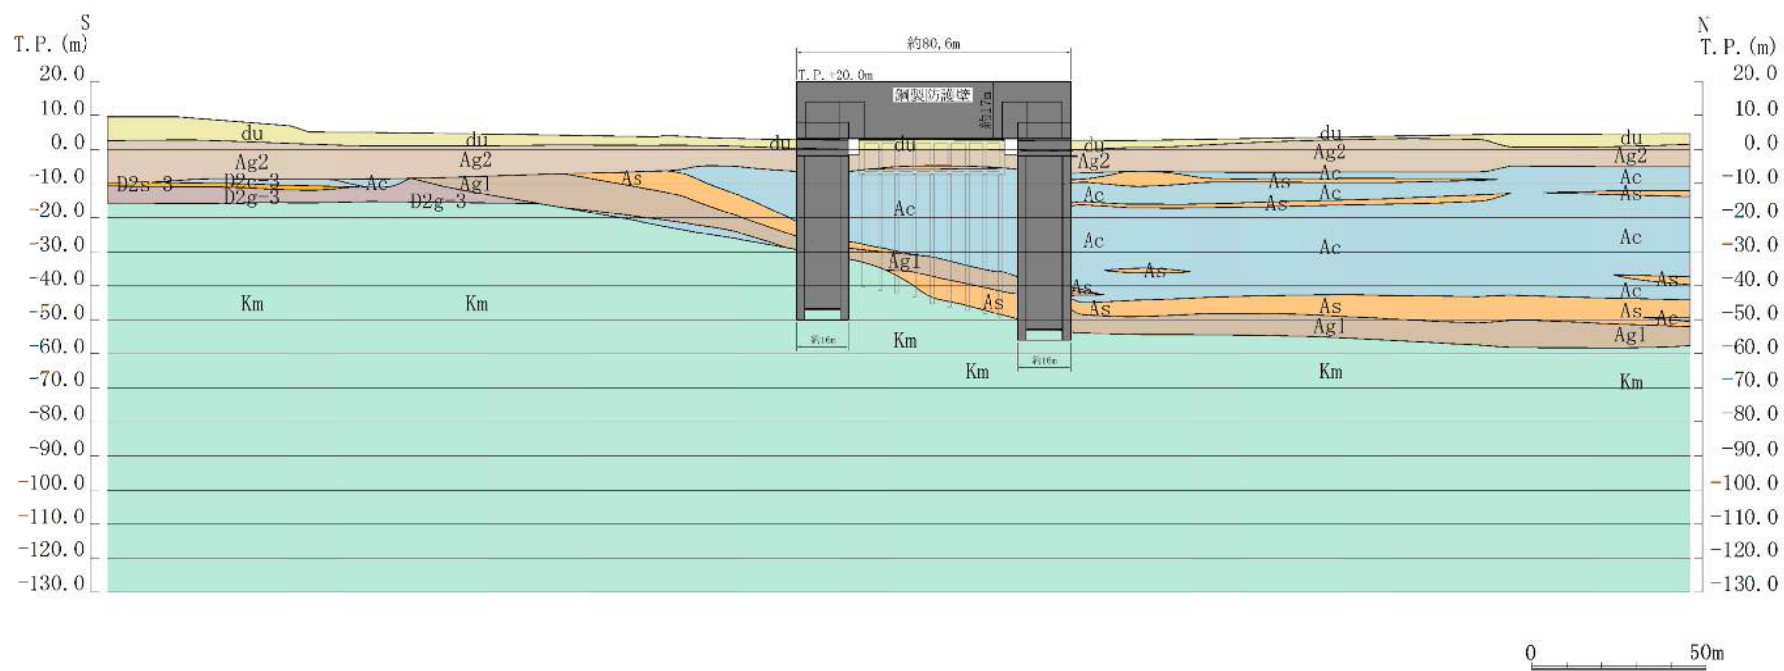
(1) 鋼製防護壁 評価対象断面図 (①-①断面)
